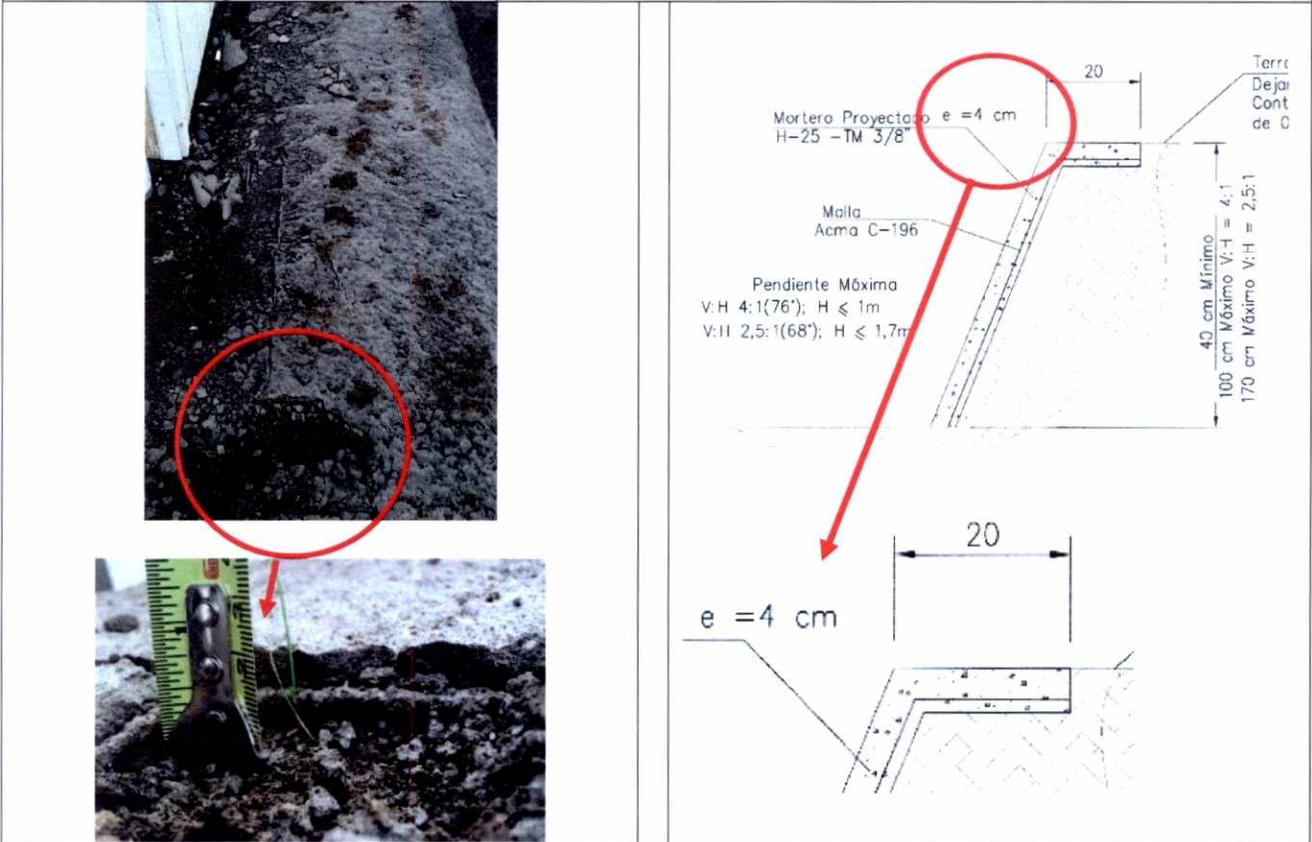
Muro shotcrete entre viviendas B-05/B-06 e imagen de muros proyectados en lámina N° 2 "Muros shotcrete", del proyecto modificado.
